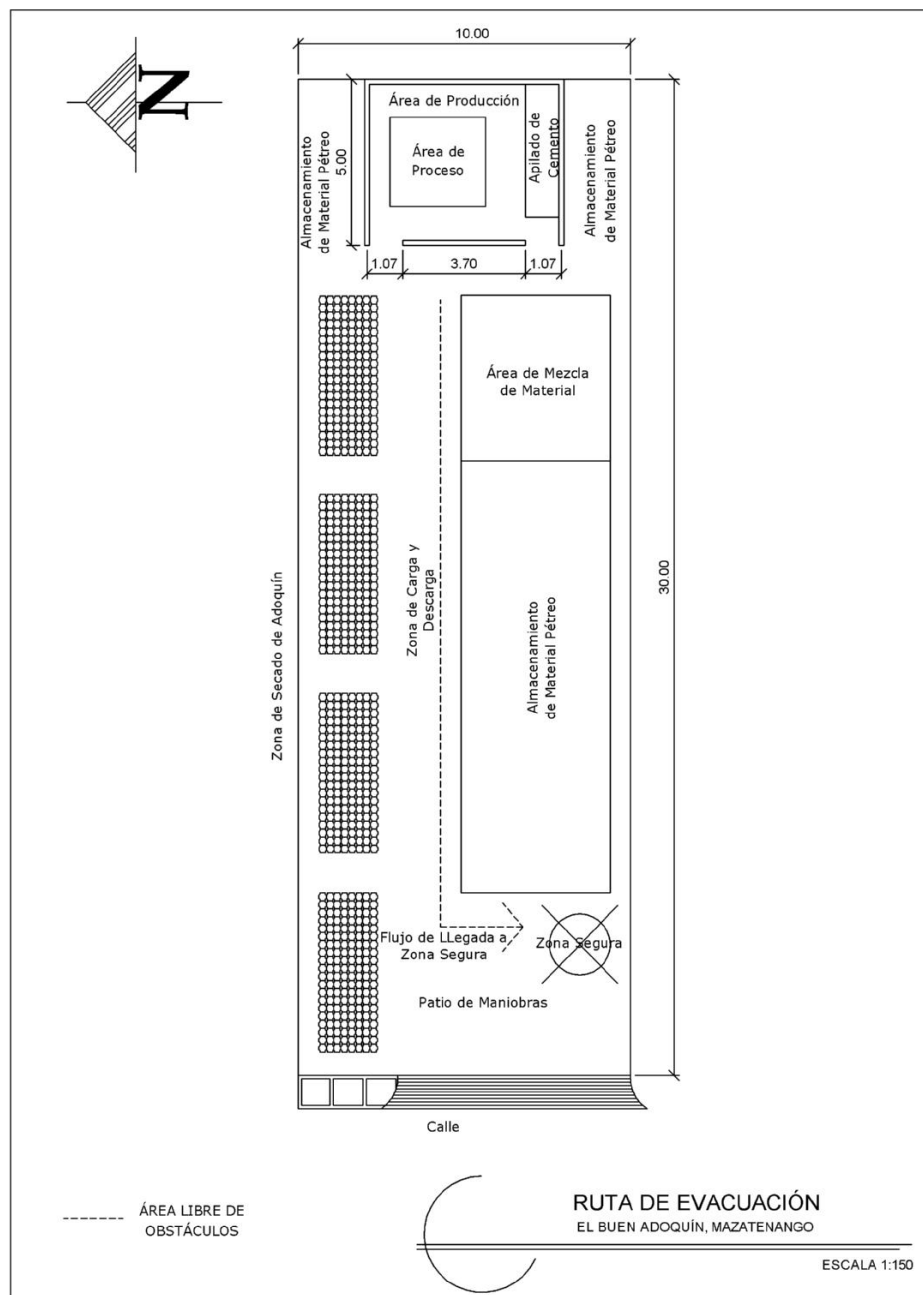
Planta de Conjunto Proyecto Mazatenango.
